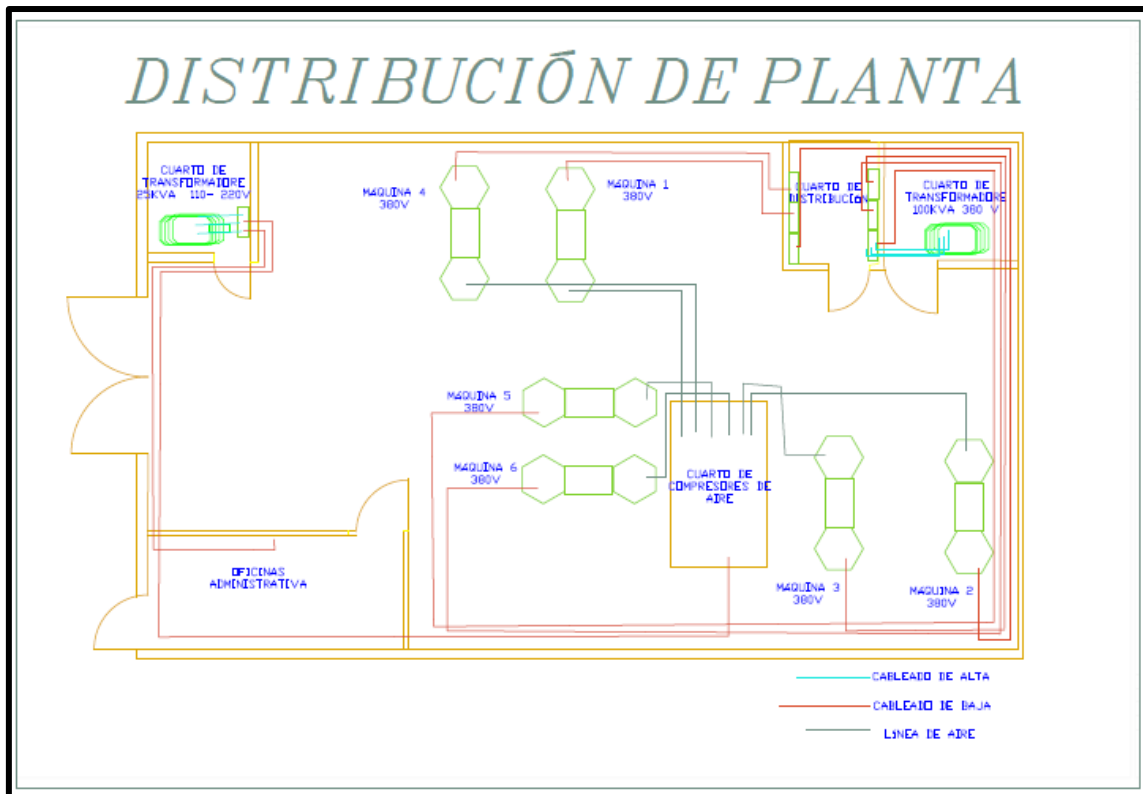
Distribución de Planta. Elaborado por DACKPOINT, (2020).
